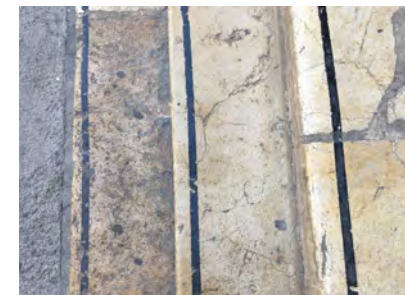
Estado de deterioro del pavimento y la señalización de los peldaños
